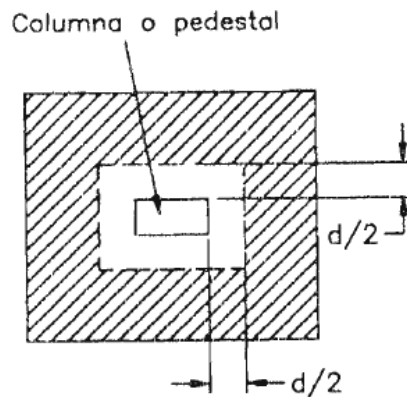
Sección crítica de corte por punzonamiento en zapatas aisladas (Harmsen, 2002)
